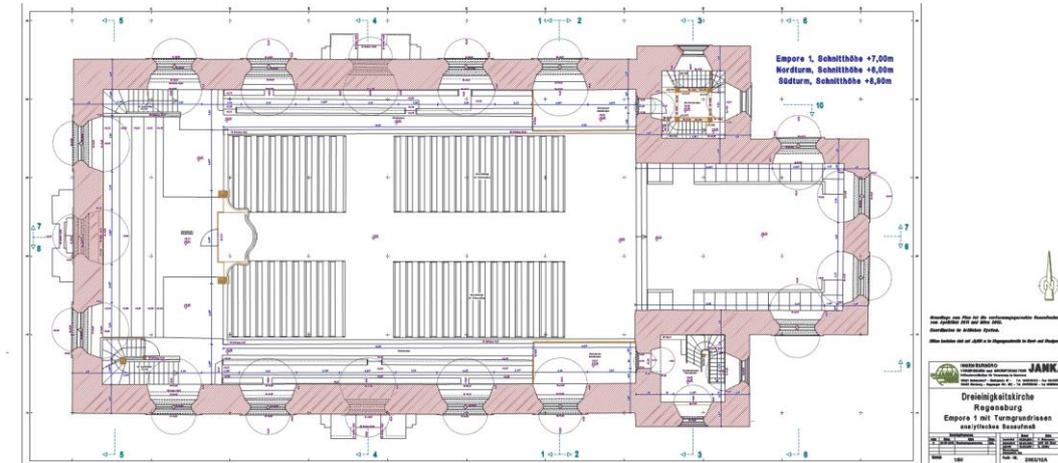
Grundriss der Dreieinigkeitskirche
